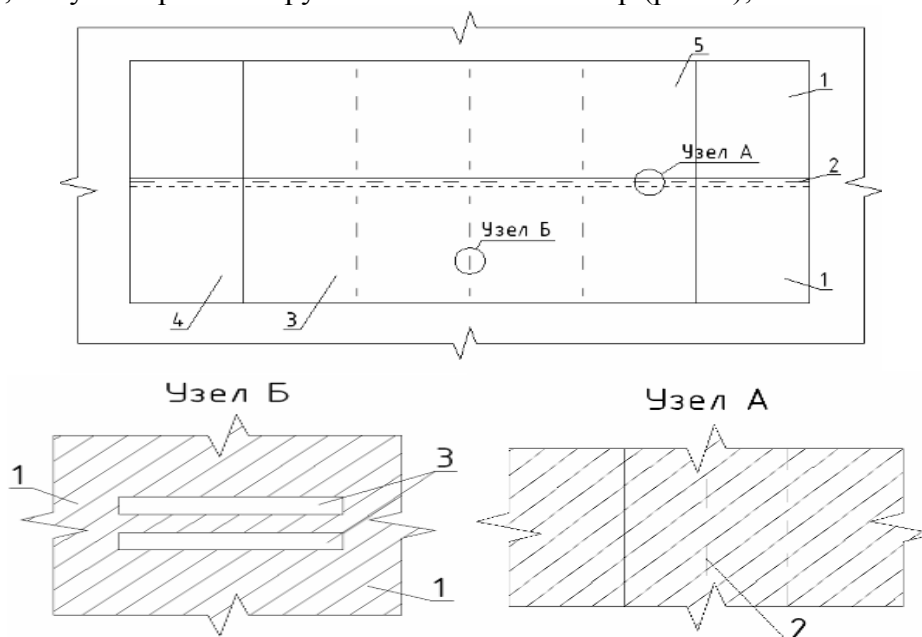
Раскладка лицевой стенки из полотнищ (1 – полотнища для единой лицевой стенки; 2 – крепления полотнищ, композитного материала; 3 – отверстия для продевания армолент; 4 – отметка для формирования грунтонаполняемого анкера; 5 – отметка для верхней части лицевой стенки)
